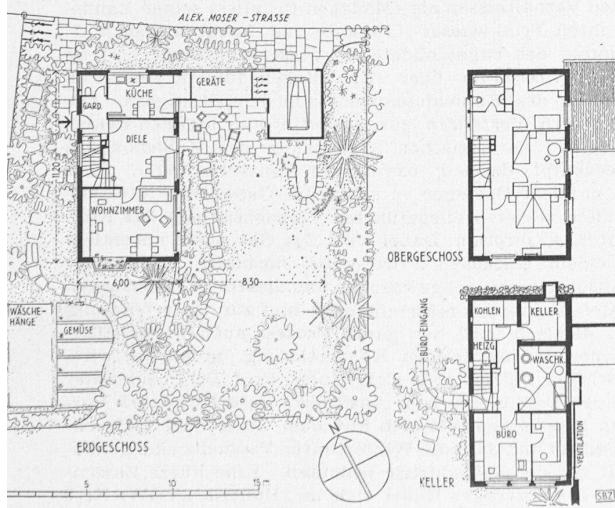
Grundrisse, Maßstab 1 : 400
